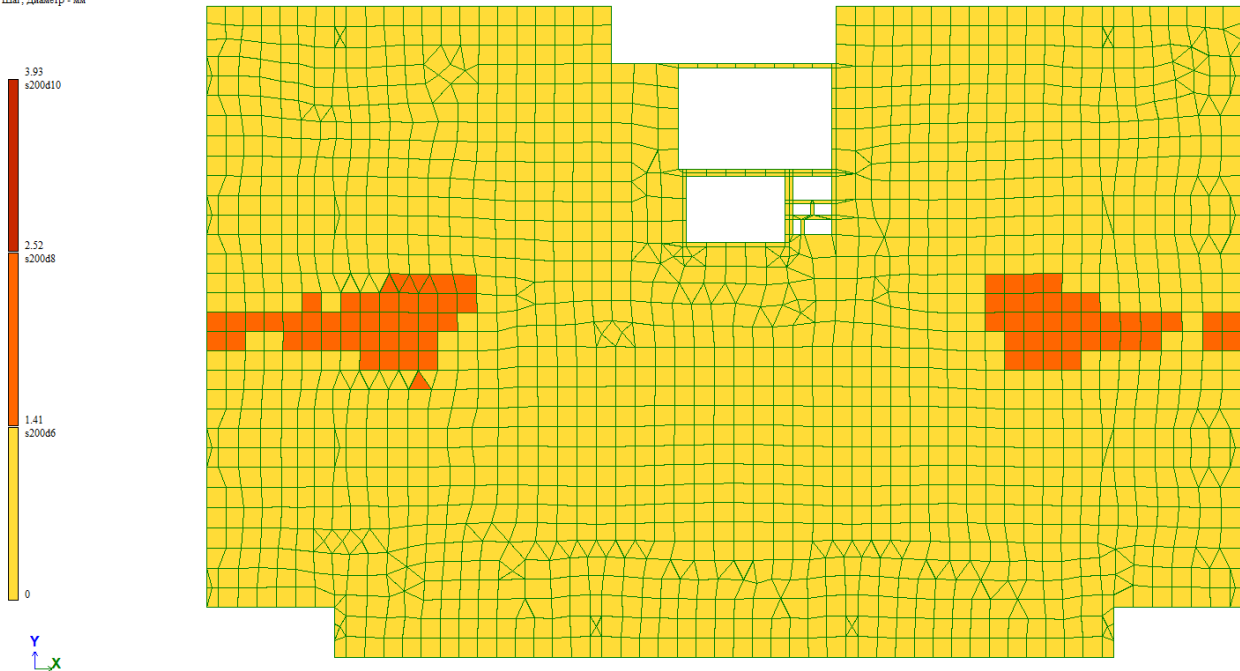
Нижнє армування плити перекриття вздовж осі У
